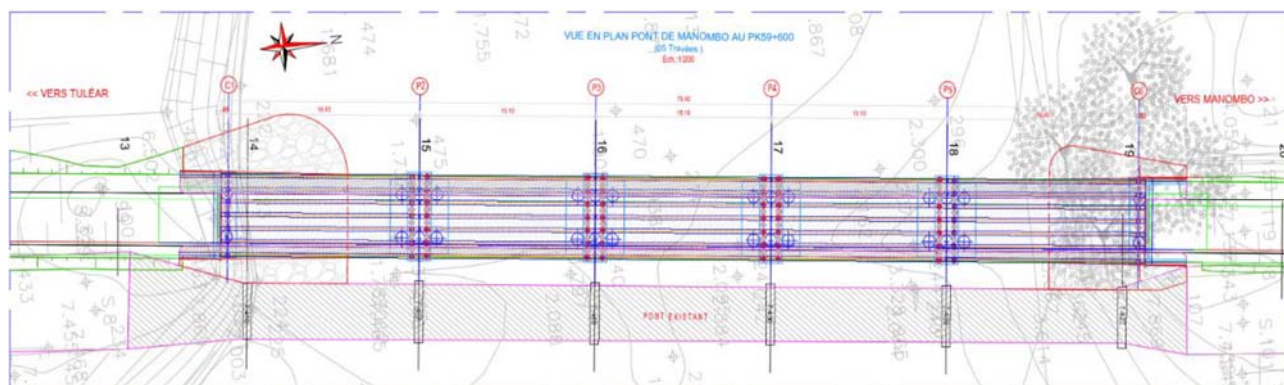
Tracé en plan de la variante 1 du pont de Manombo
